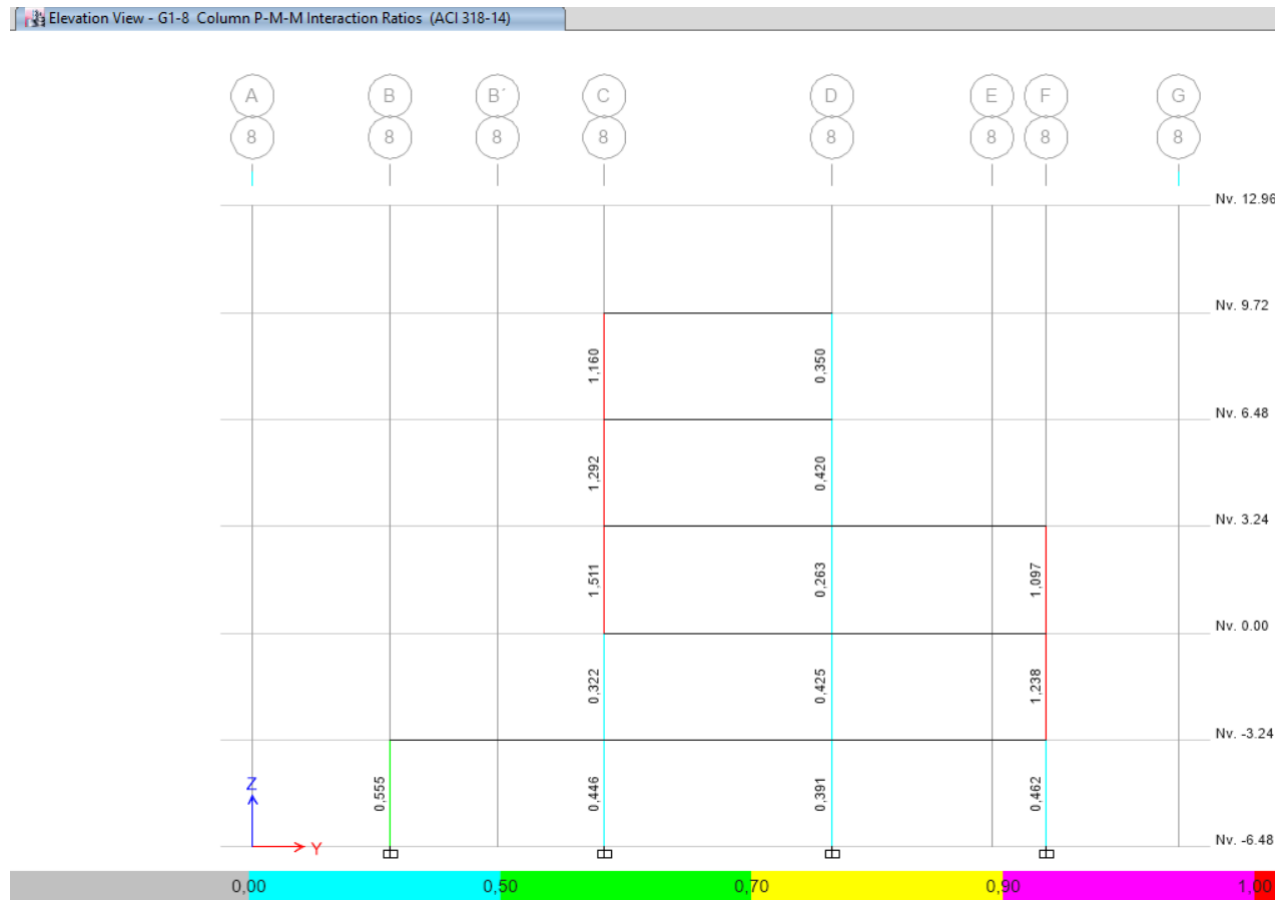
Vista en elevación de la demanda/capacidad en columnas, pórtico eje 7.
